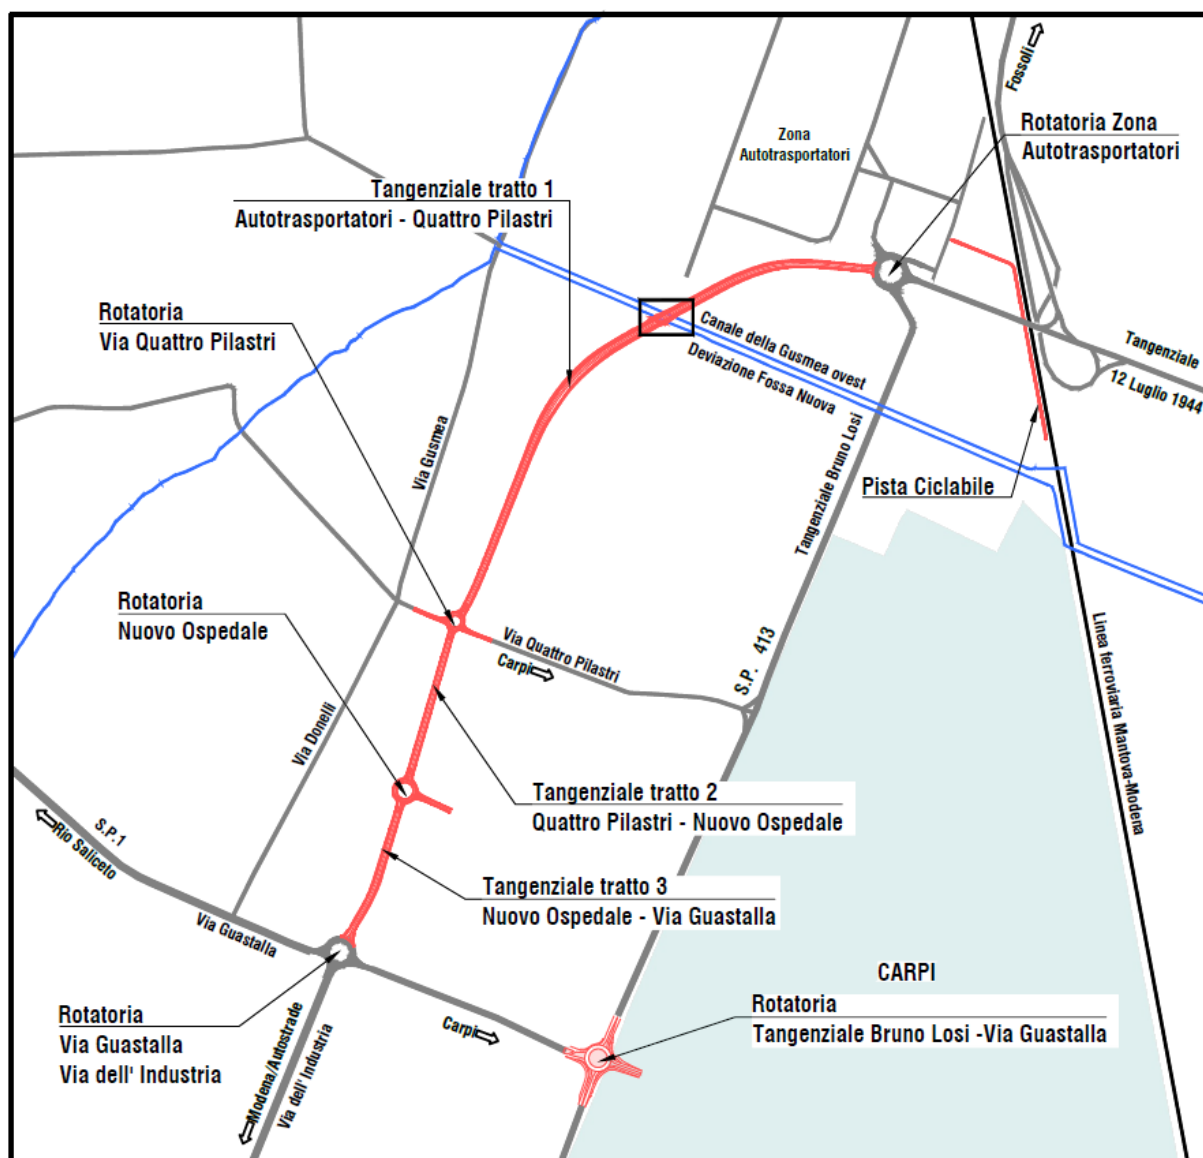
Planimetria generale: inquadramento delle opere.
